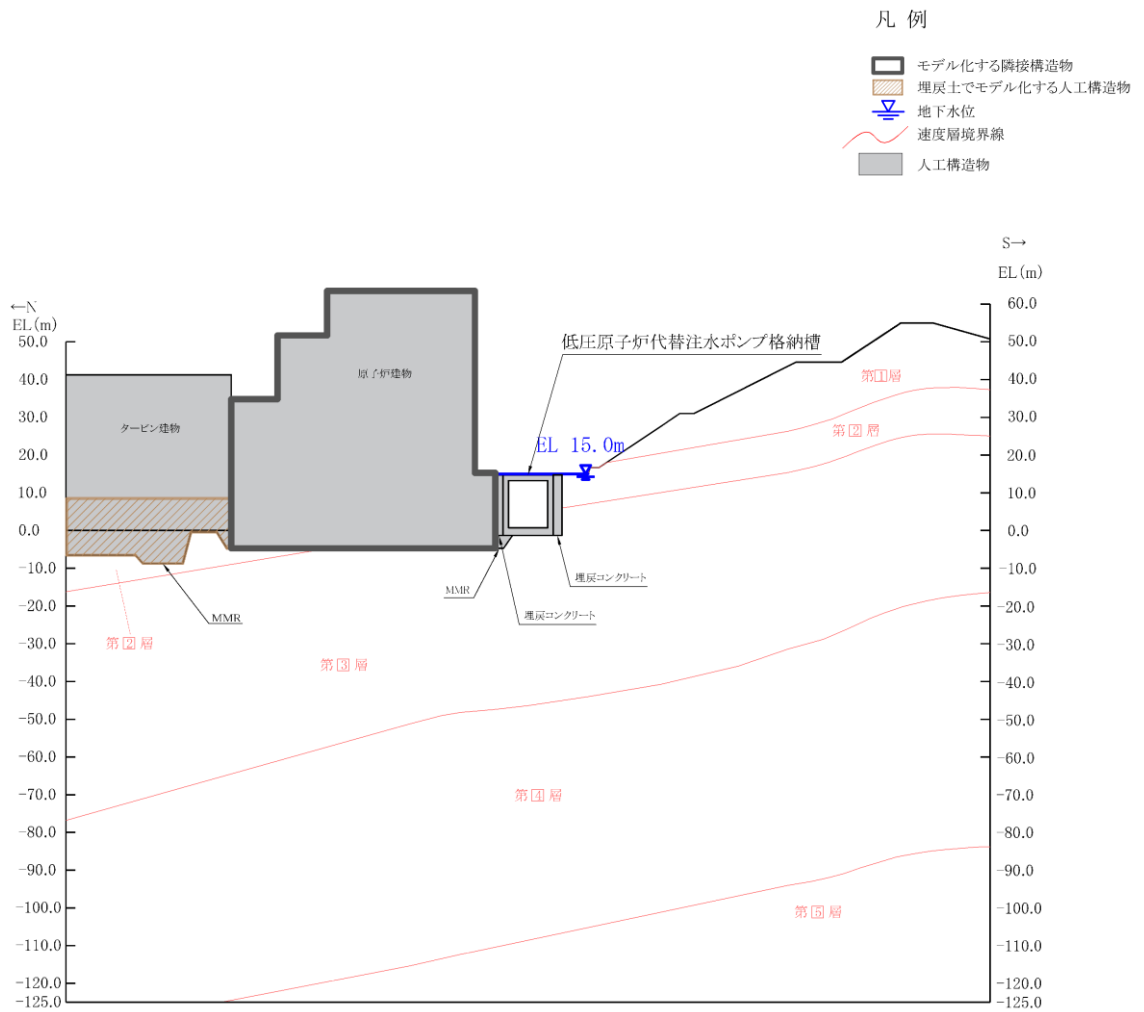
低圧原子炉代替注水ポンプ格納槽 断面図 (B-B 断面位置)
